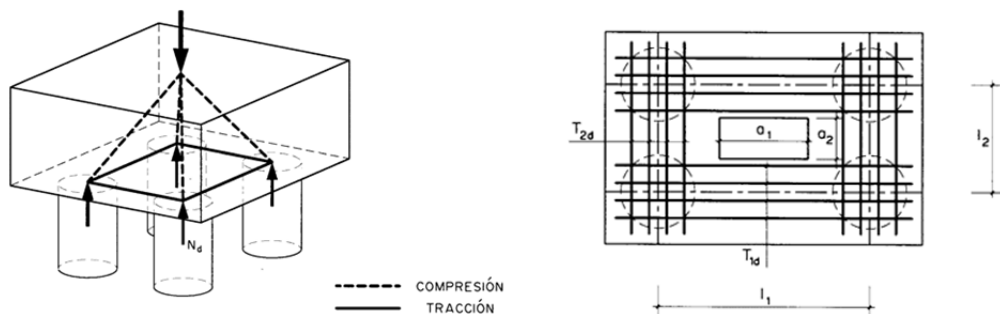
Modelo para encepado sobre cuatro pilotes
